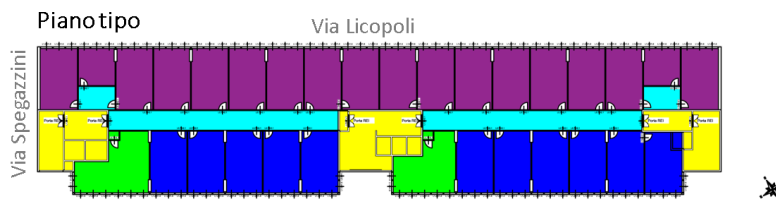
Pianta del dal 1° al 6° (pianta tipo).
